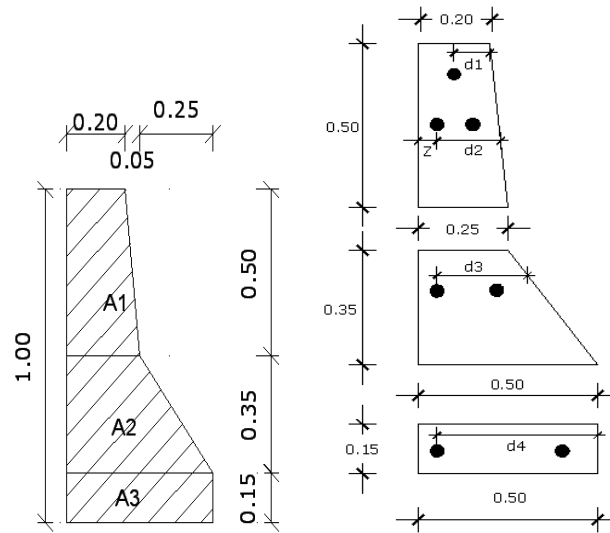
2 Segmentos A1, A2, A3 de la sección transversal del parapeto
